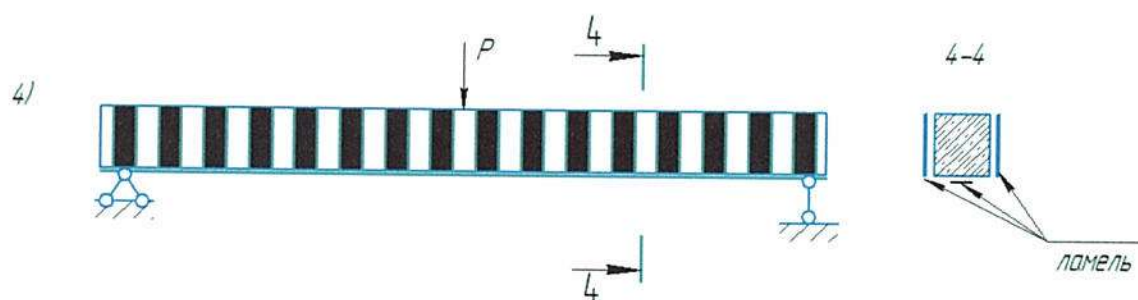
Испытание перемычек с усилением ламелями по нормальным и наклонным сечениям (вар.2). Серия ПуІV
